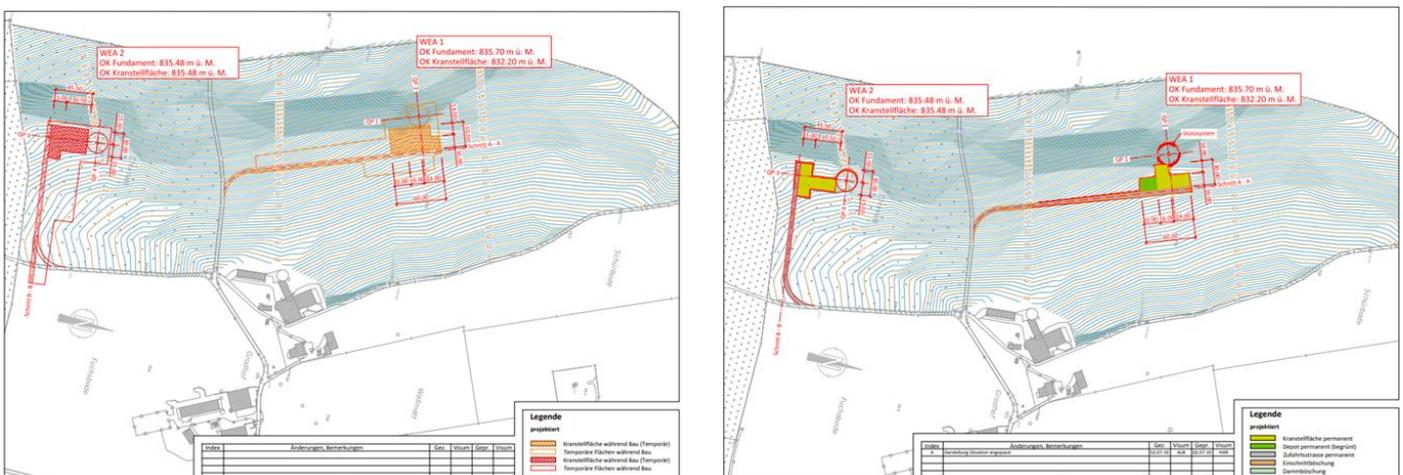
Standorte WEA 1 und WEA 2 im Teilperimeter Grod während der Bauphase (links) und im Betrieb (rechts). Die Kranstellflächen werden teilweise zurückgebaut oder wiederbegrünt. Darstellung nicht massstäblich.
